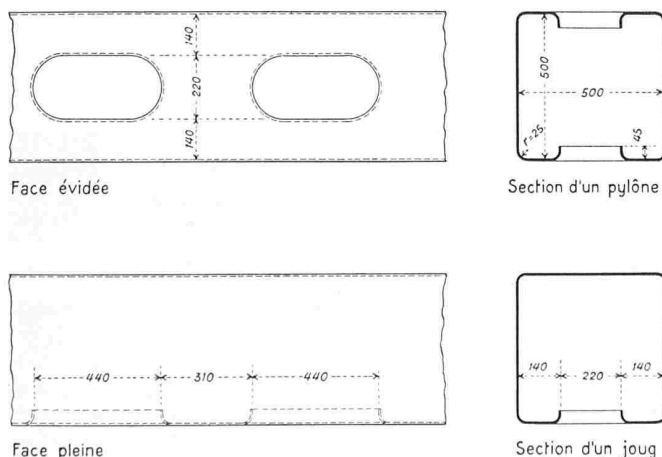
Dimensions des jous et des pylônes, échelle 1 : 25
